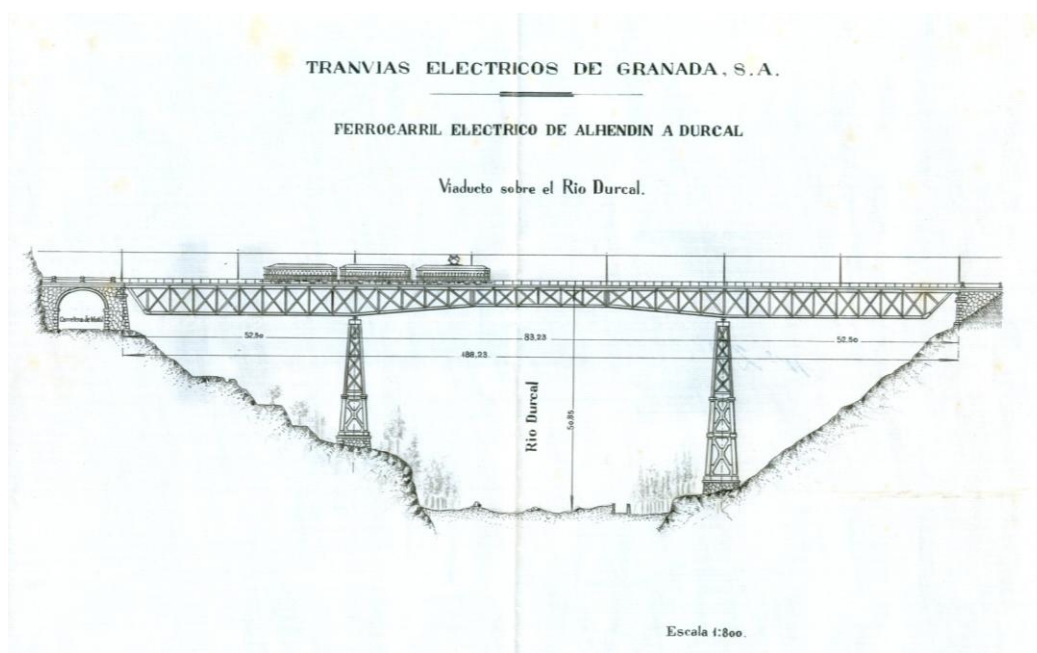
Plano de TEGSA para el nuevo Puente de Dúrcal (originalmente, a escala 1/800). Fuente: Colección privada Jesús Ferro.
